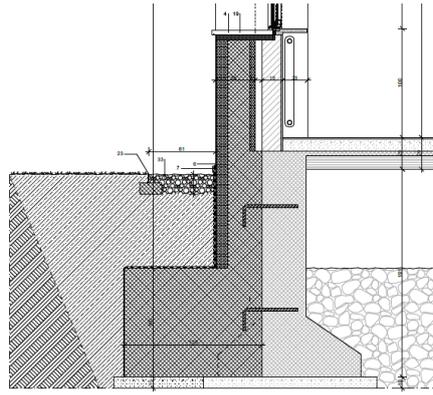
Collegamento delle nuove fondazioni del cappotto sismico alle fondazioni esistenti
